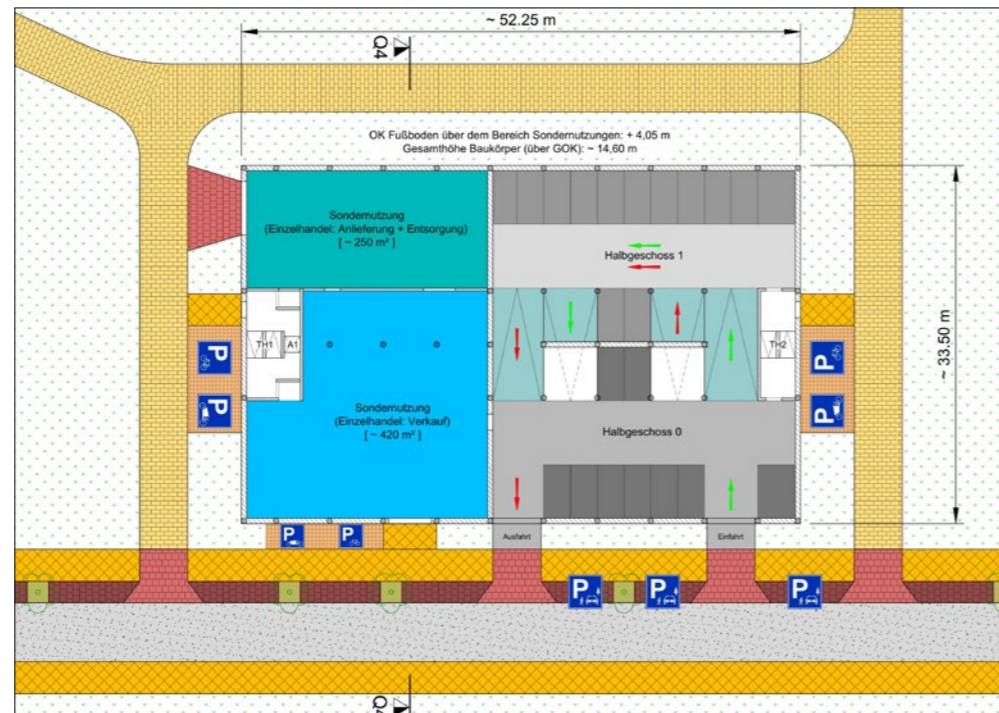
Planskizze einer Bewohnersammelgarage mit Einzelhandelseinrichtung
